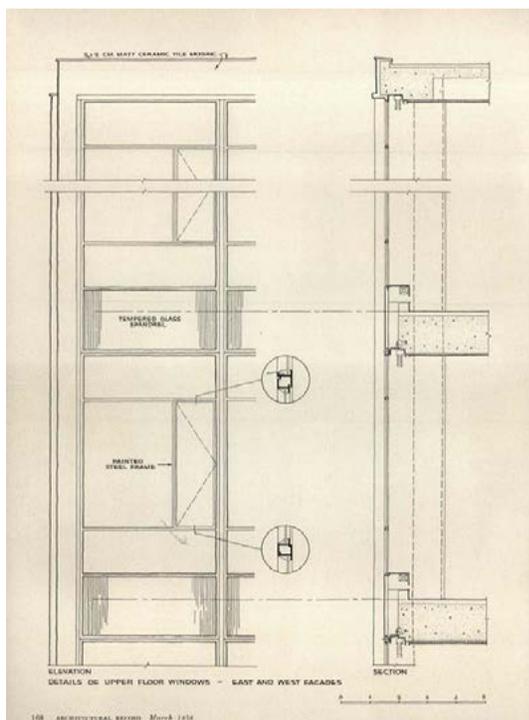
Detalle Spandrelite en fachada. Revista Architectural Record, p. 168, 1958,
